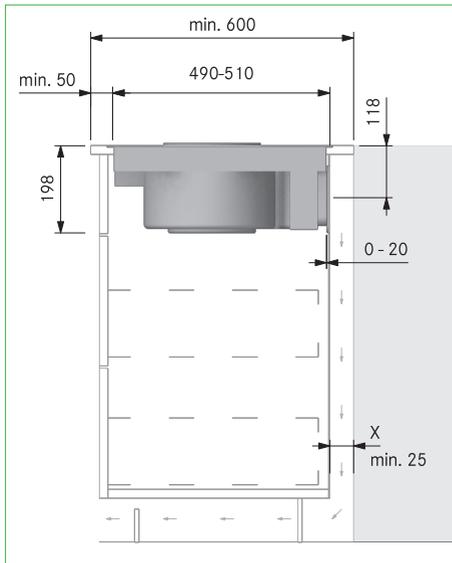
Dimensions de montage, profondeur de plan de travail 600 mm
